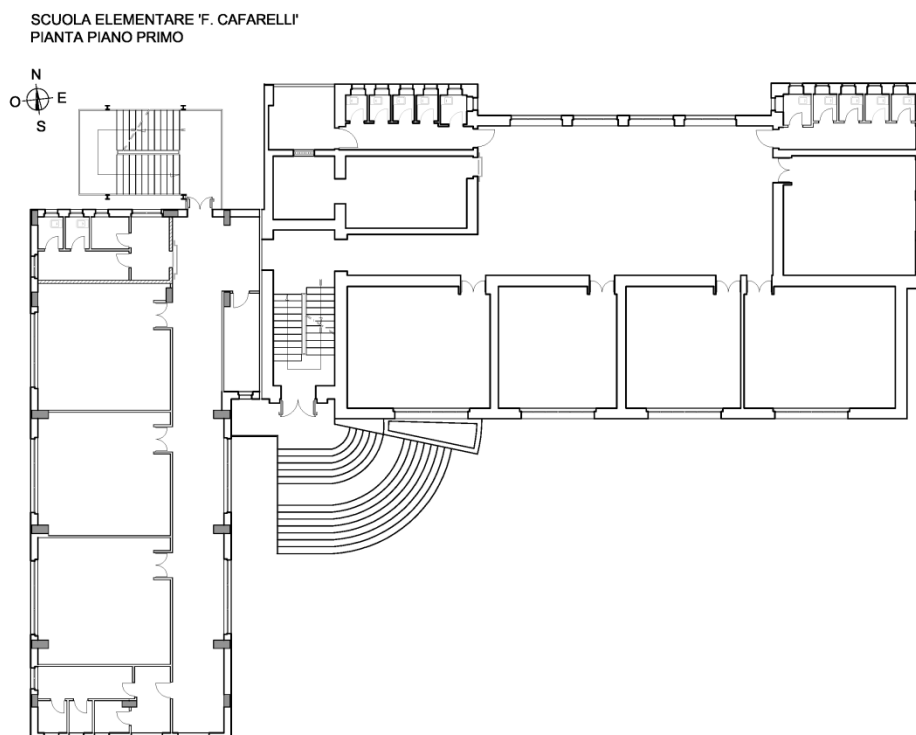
Complesso scolastico F. Cafarelli: pianta primo piano
